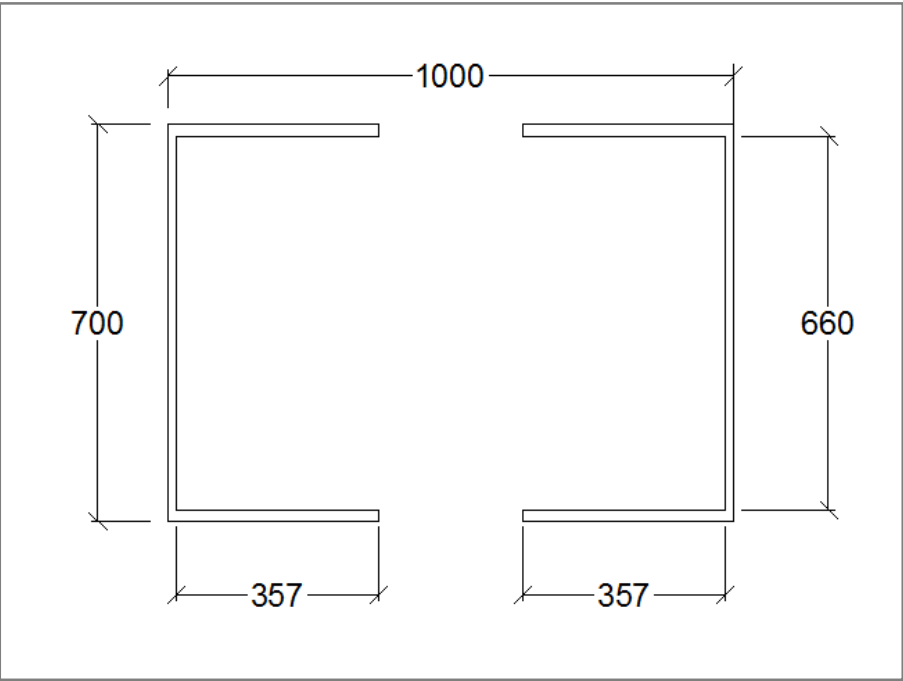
Sección reducida por flector de eje 3 en vigas longitudinales de calzada (cotas en mm)
